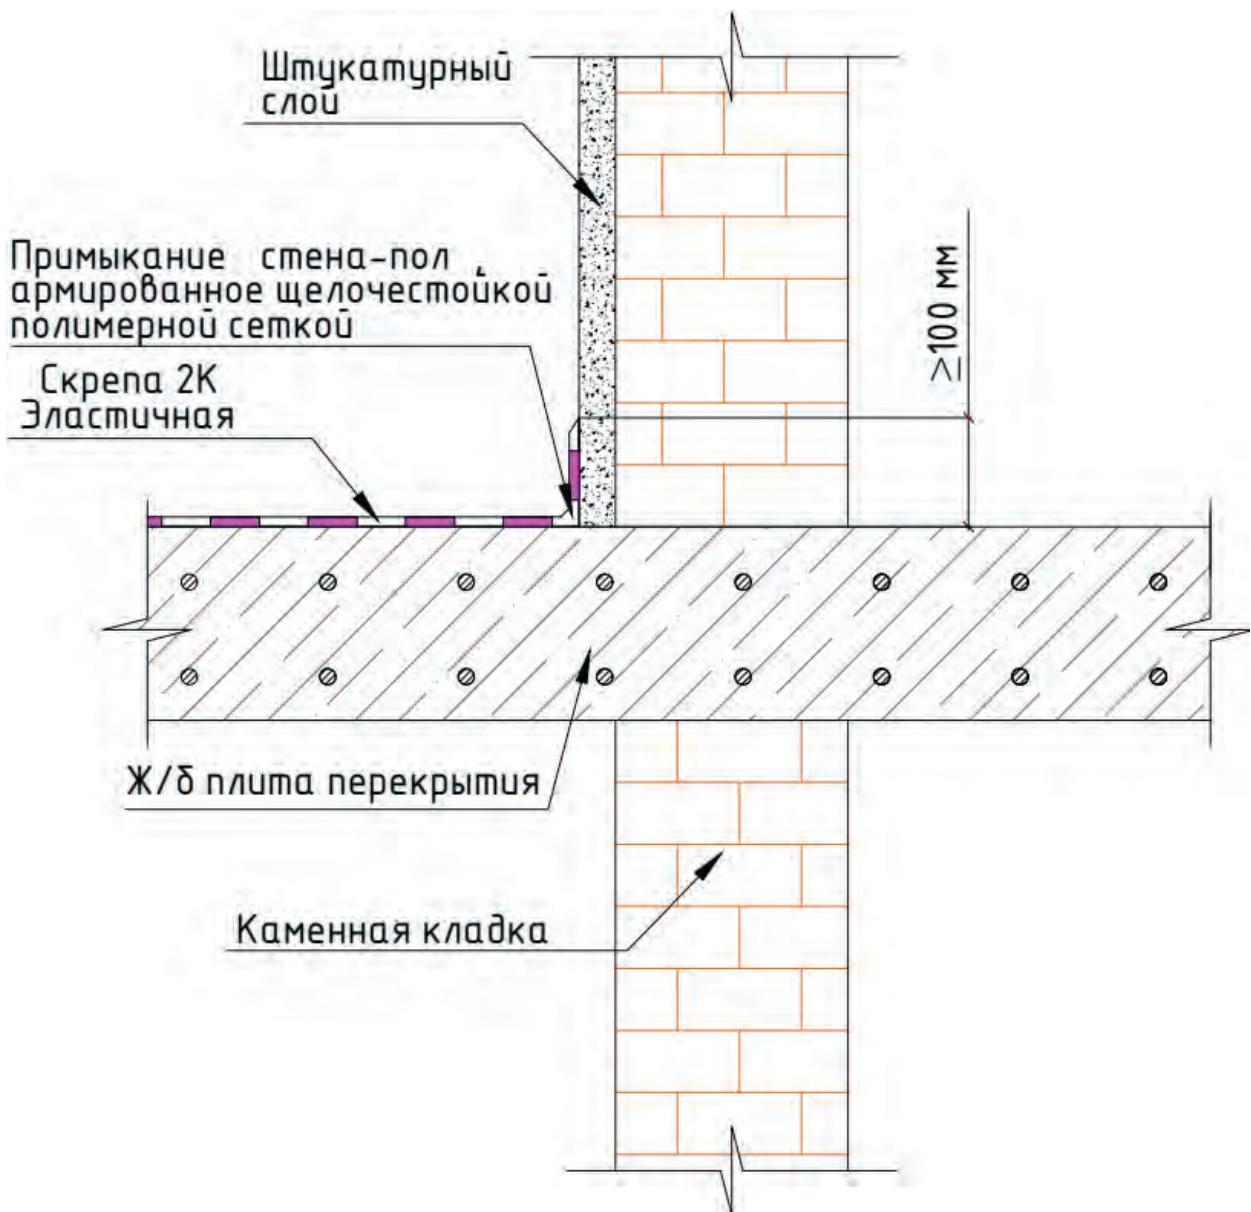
Схема гидроизоляции санитарно-технических узлов
